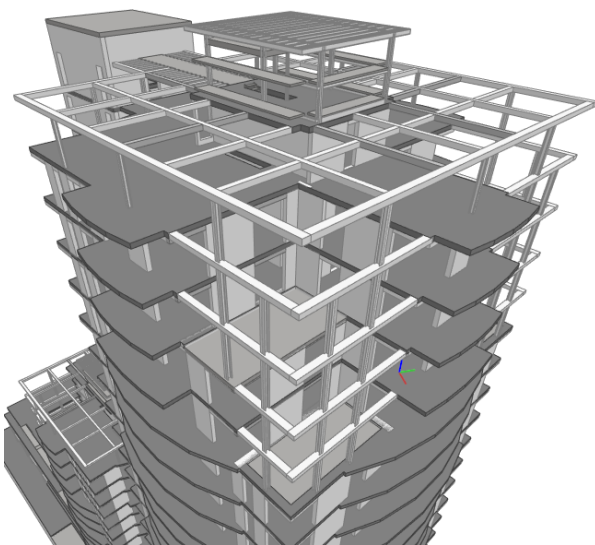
Detalle modelo ifc de estructura plantas superiores Torre A [1]
